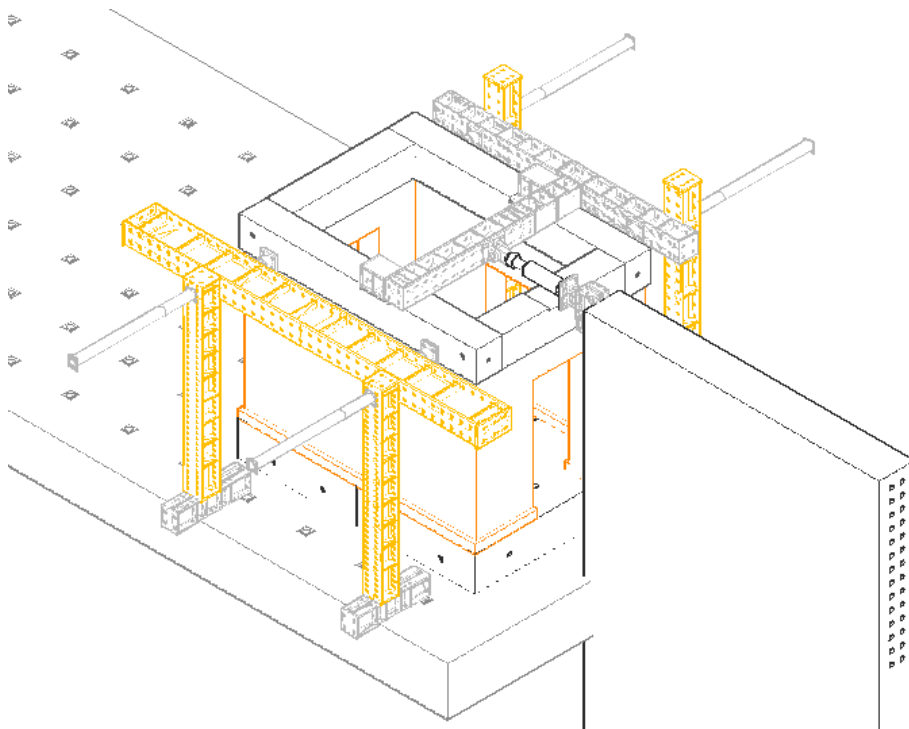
Projeto do modelo de adobe (Fachada Norte/Oeste)
